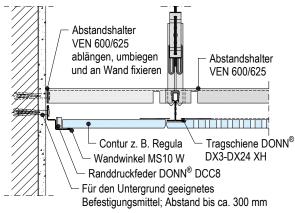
de-A10 Anschluss an Wand mit Wandwinkel
